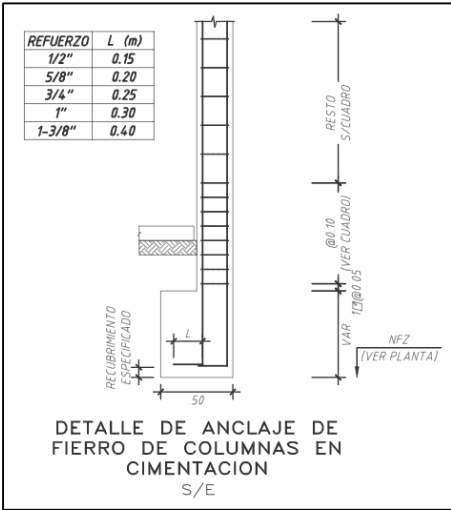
Extracto de detalle de Anclaje de Fierro de columnas en cimentación
